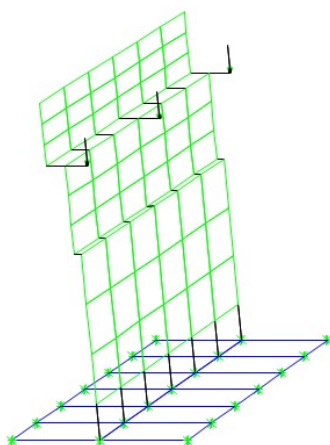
Modello della spalla con relativo basamento di fondazione in vista 3D
